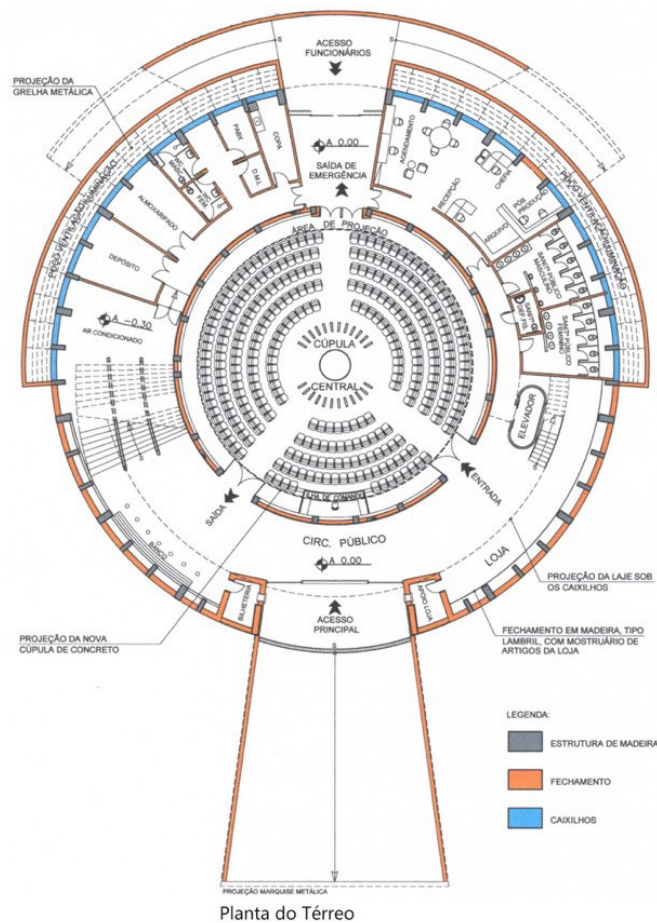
Planta Baixa do Planetário do Ibirapuera
